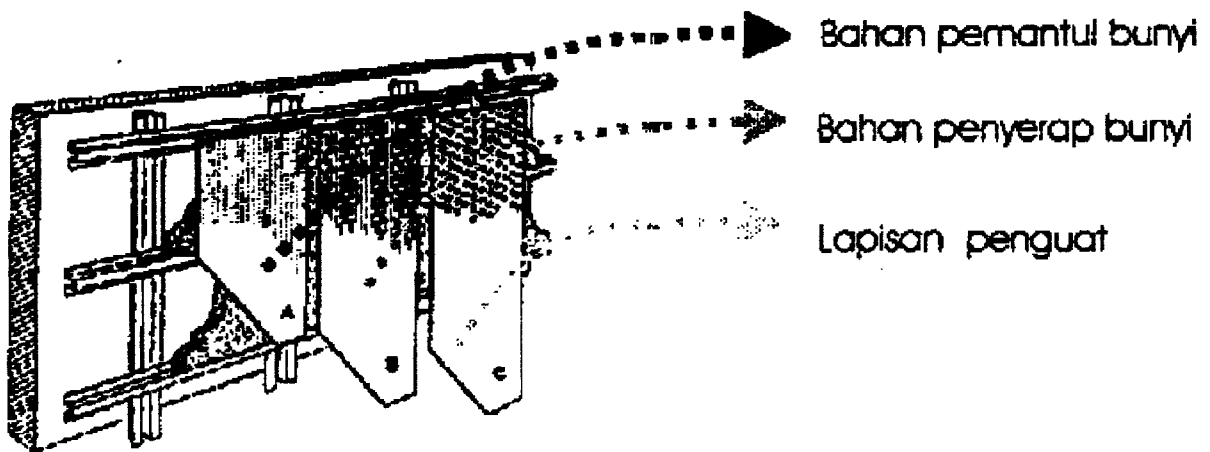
Plafon Sebagai Bidang Pantul
